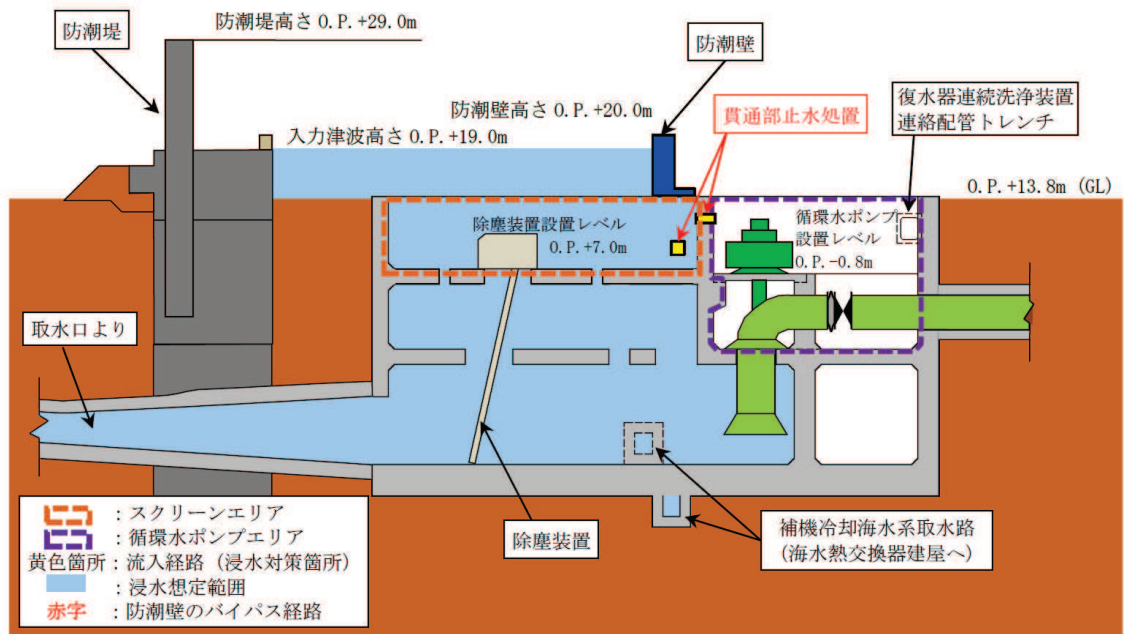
第 3 号機 海水ポンプ室 流入対策配置図 (A-A 断面図)
